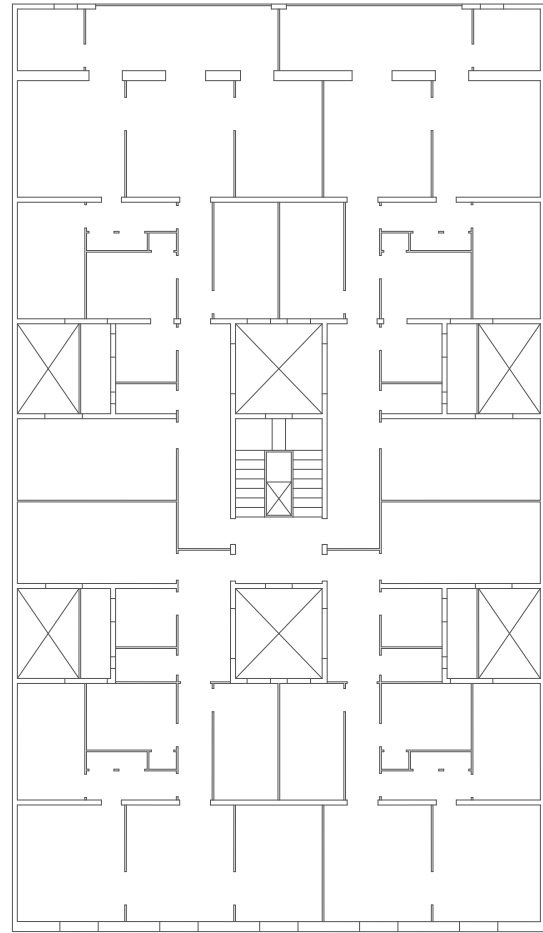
Vista en planta de plantas tipo del edificio ED-01 (fuente: elaborado por el autor)
